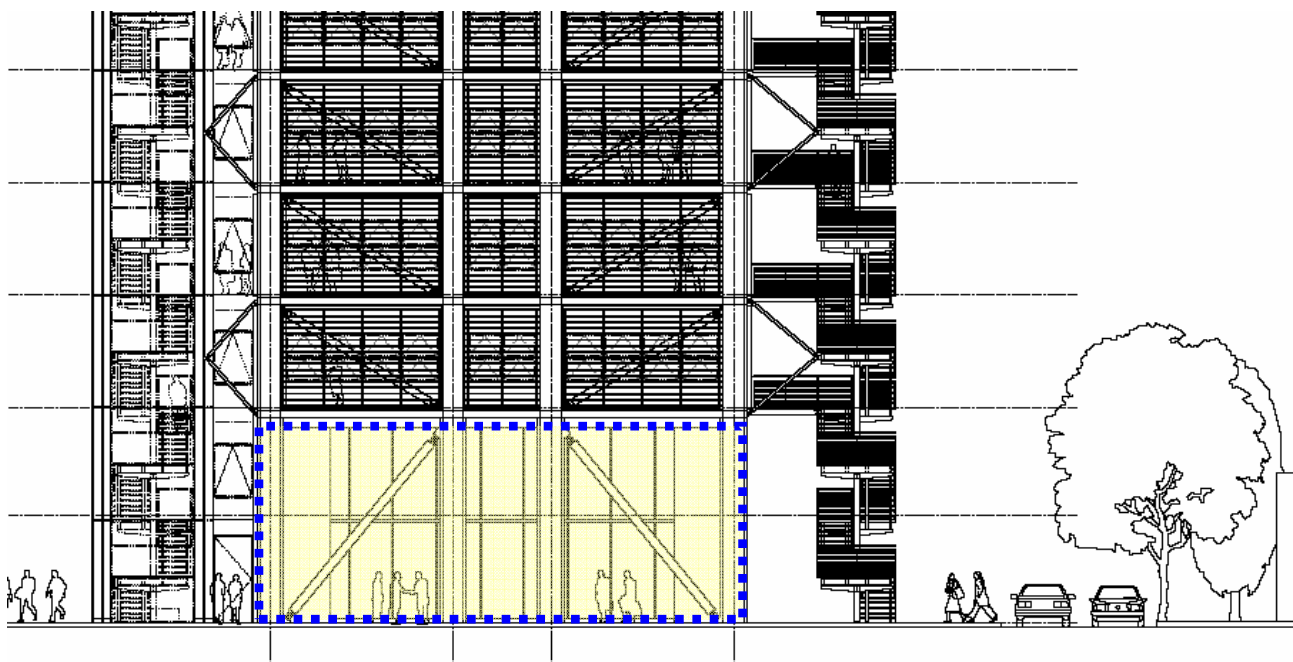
Indicazione in prospetto della facciata oggetto di valutazione
